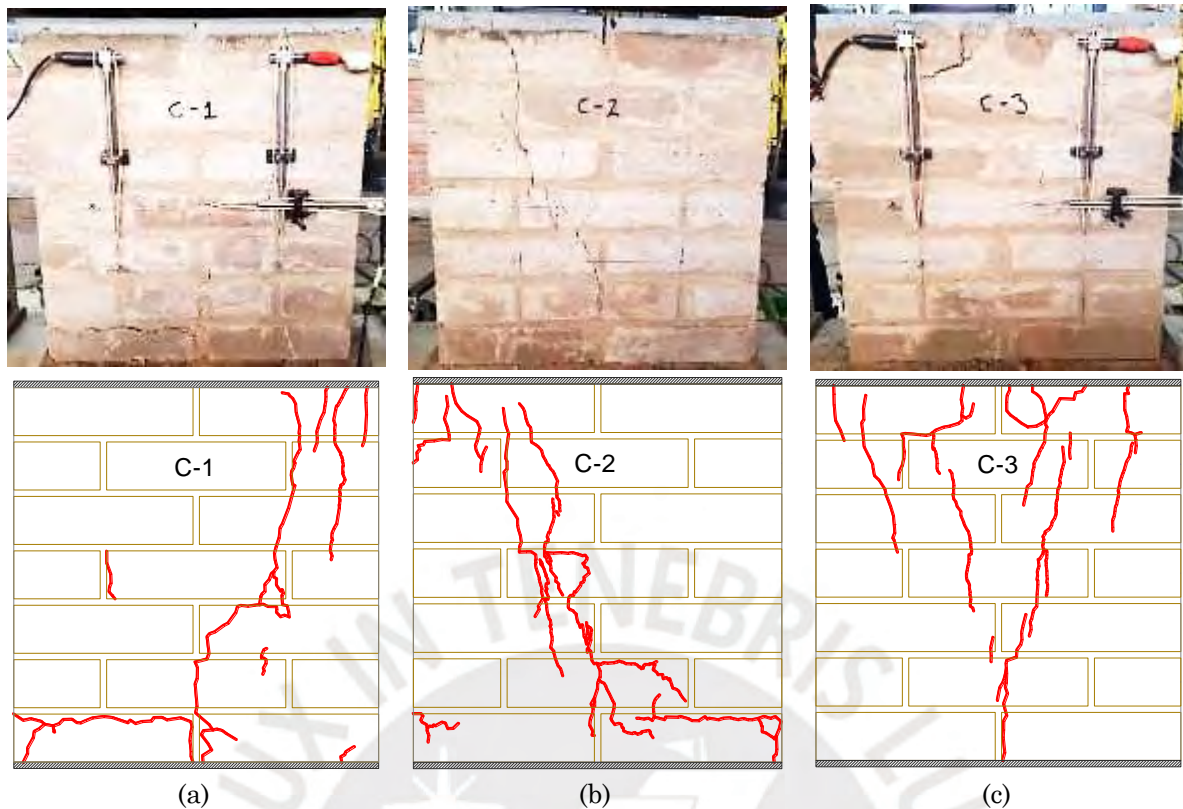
Mecanismos de falla: (a) murete C-1, (b) murete C-2, y (c) murete C-3.
